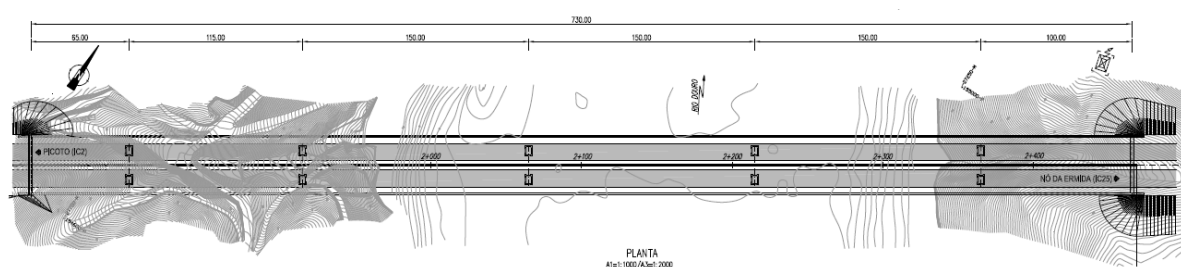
Vista em planta da Ponte sobre o Rio Douro em fase de projeto e distribuição dos respetivos vãos
